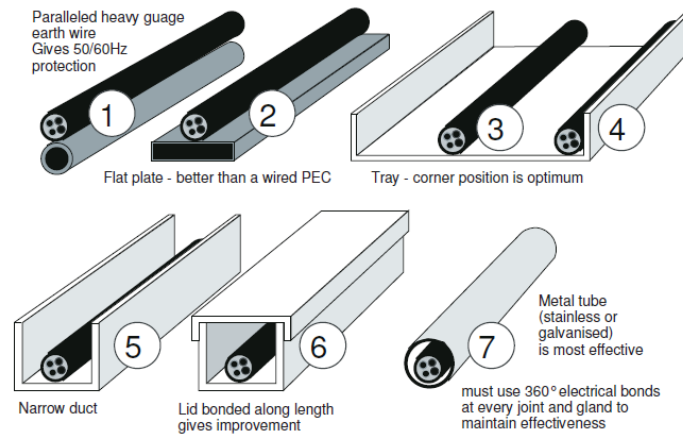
Classement par niveau de protection des conduits métalliques [69]
